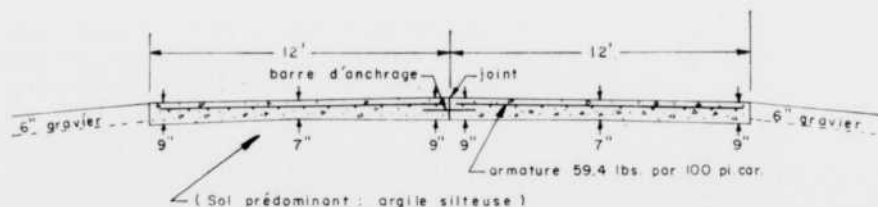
Essai routier MD-1. — Section type du pavage.
